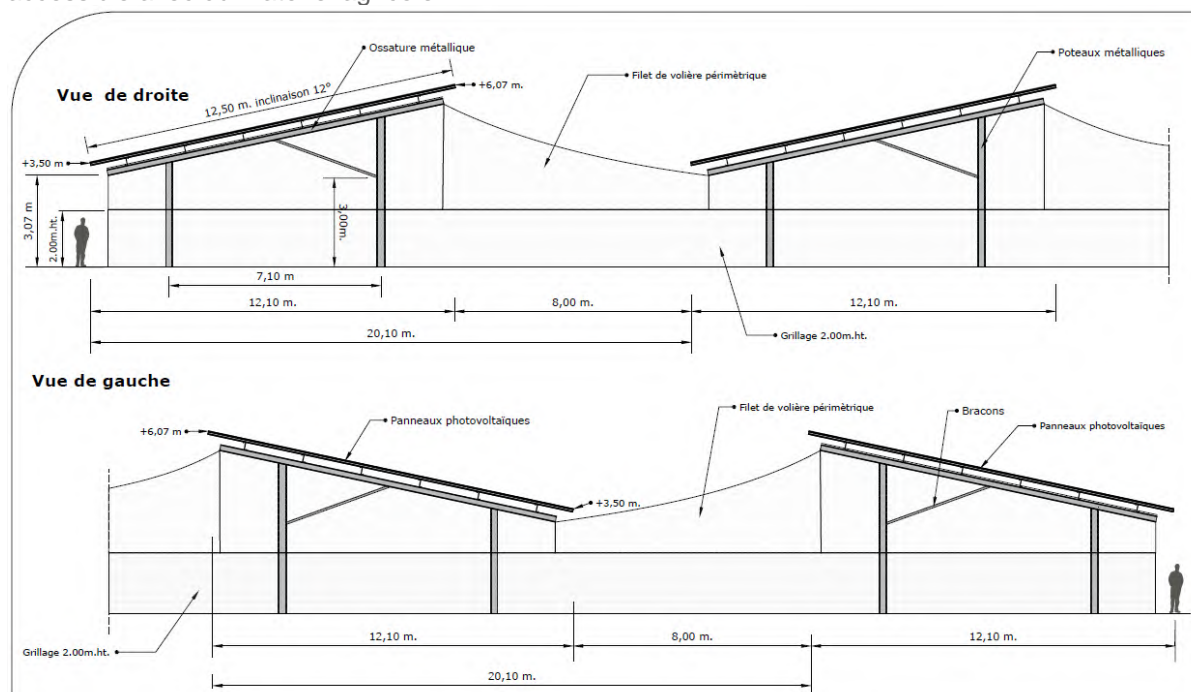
Plan de coupe du futur bâtiment de desserrage
